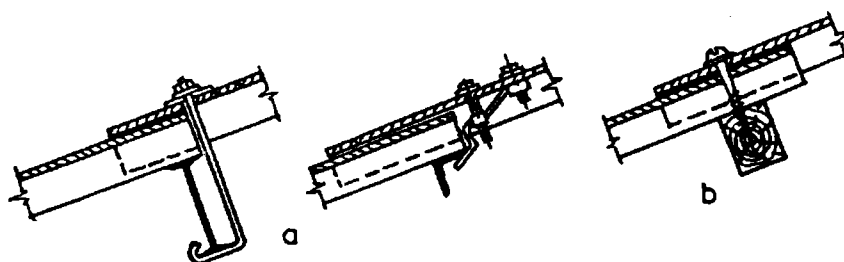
Detalii de fixare a plăcilor din azbociment:
